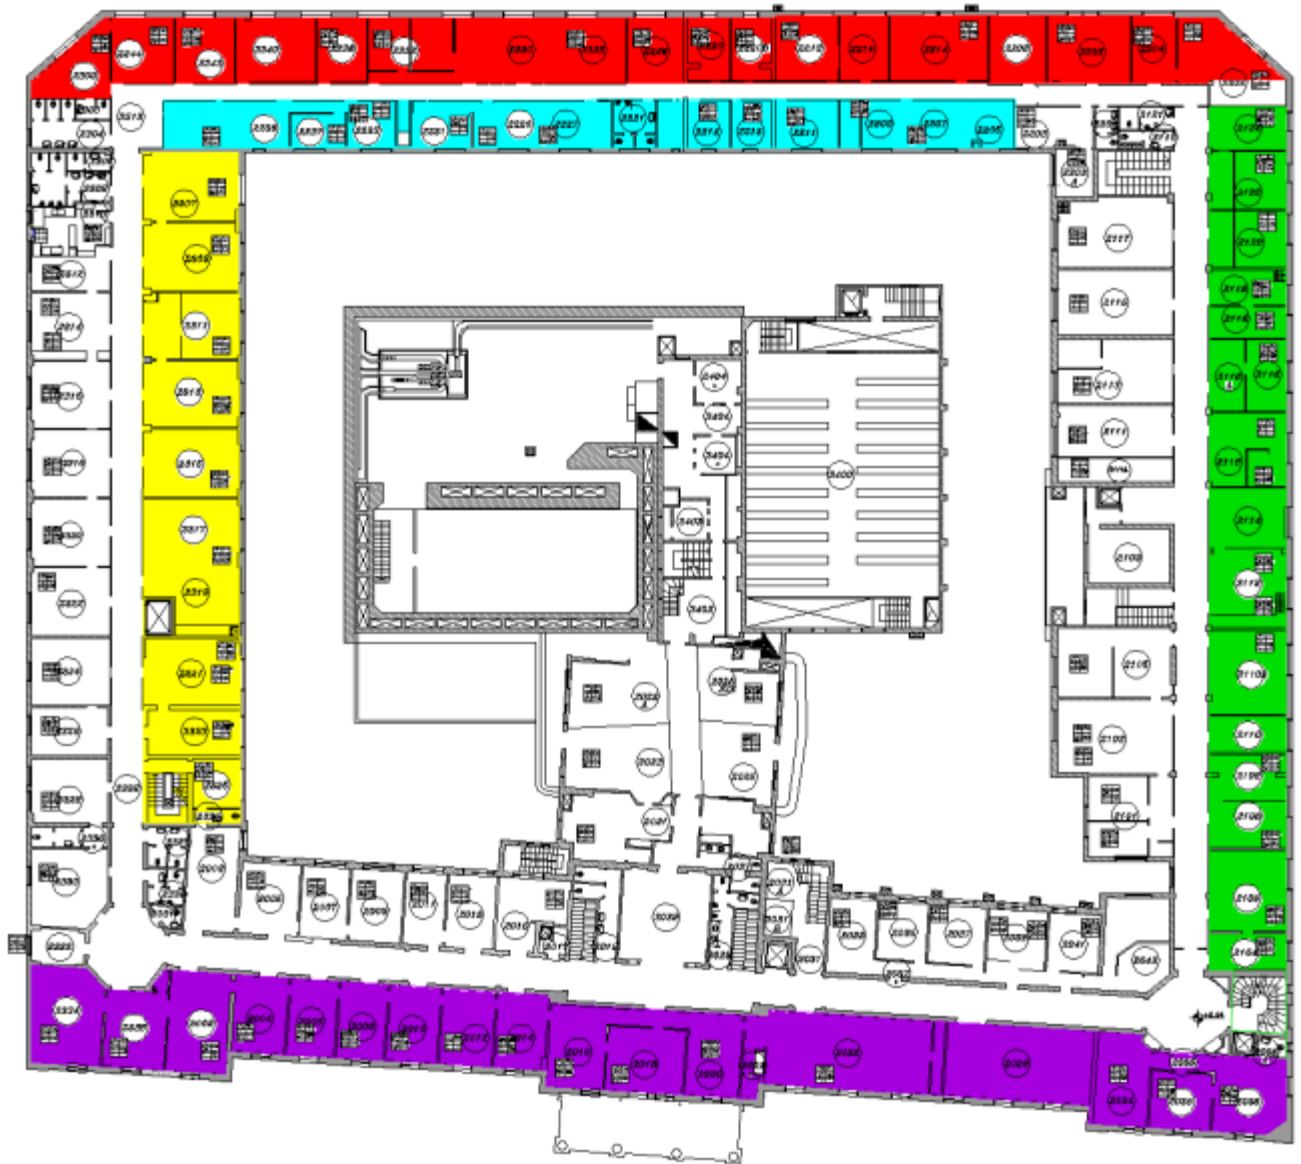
Vista en plano del edificio con delimitación de las zonas donde se puede aplicar la medida
